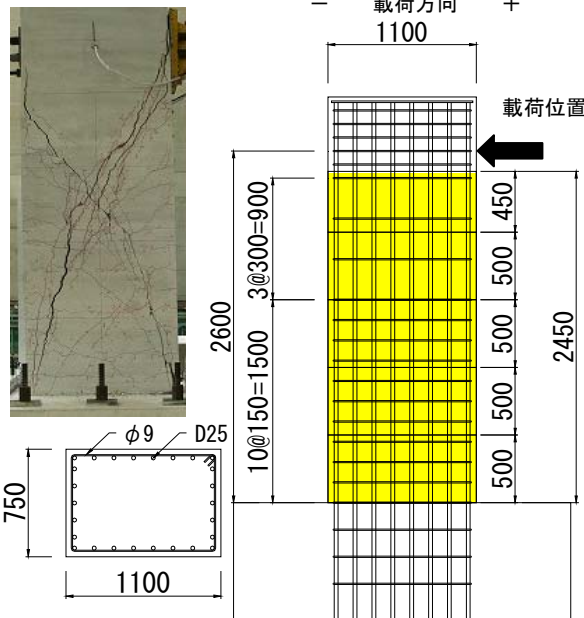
試験体寸法、配筋および事前載荷時の損傷状況
